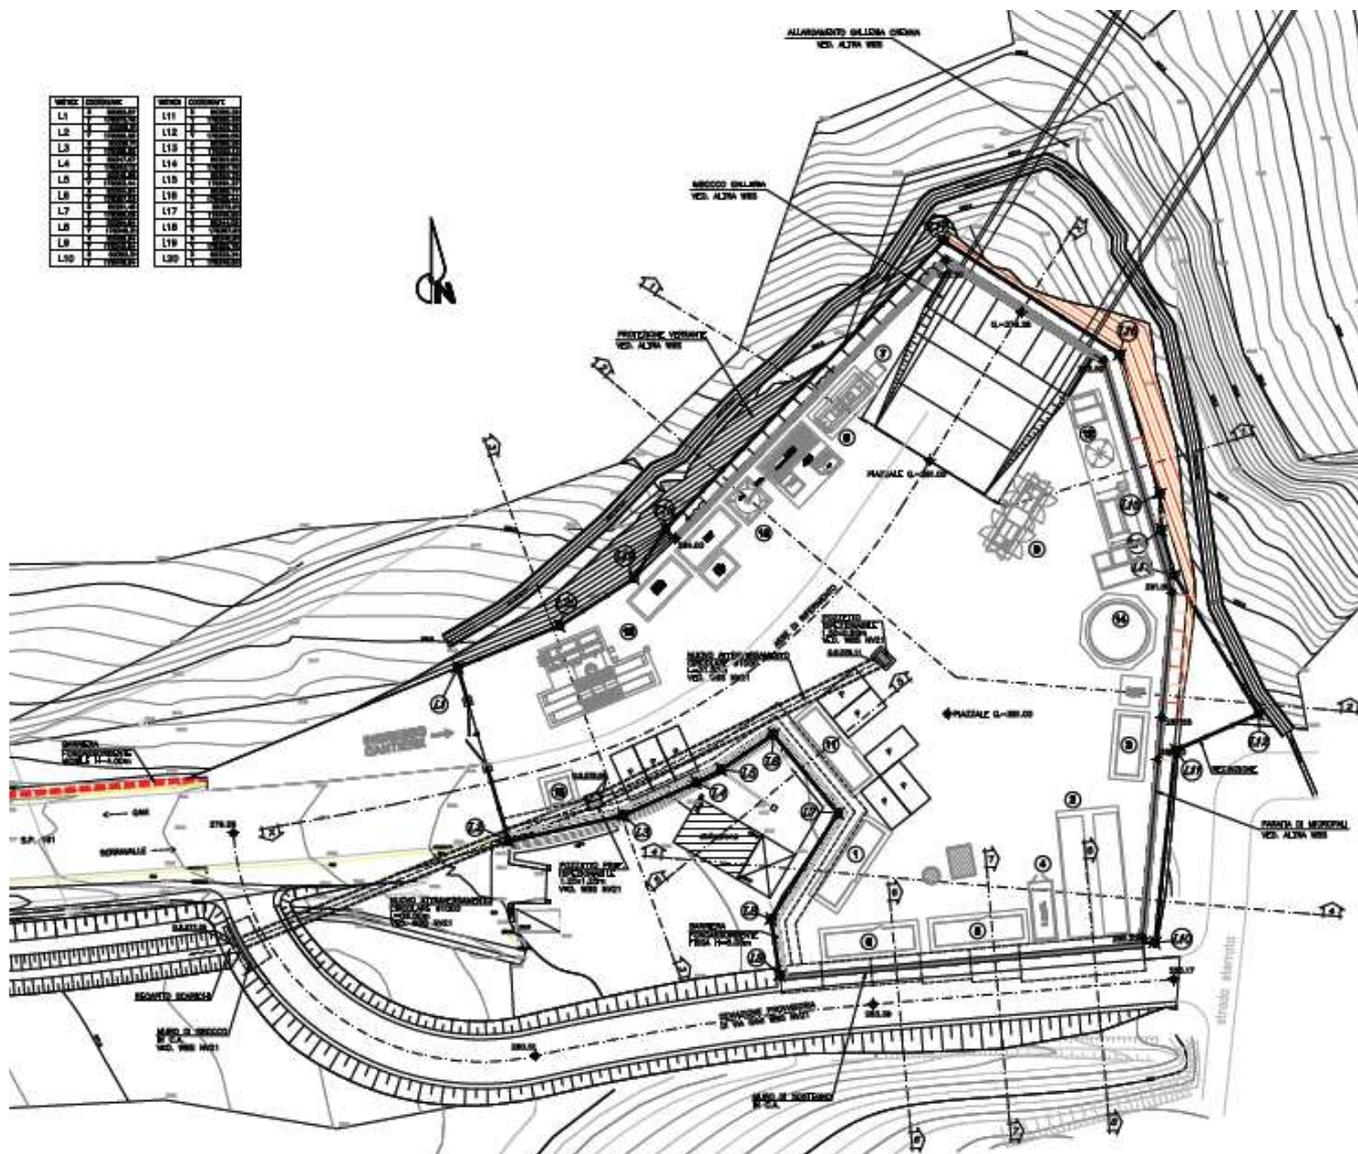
Planimetria del nuovo Cantiere Operativo
